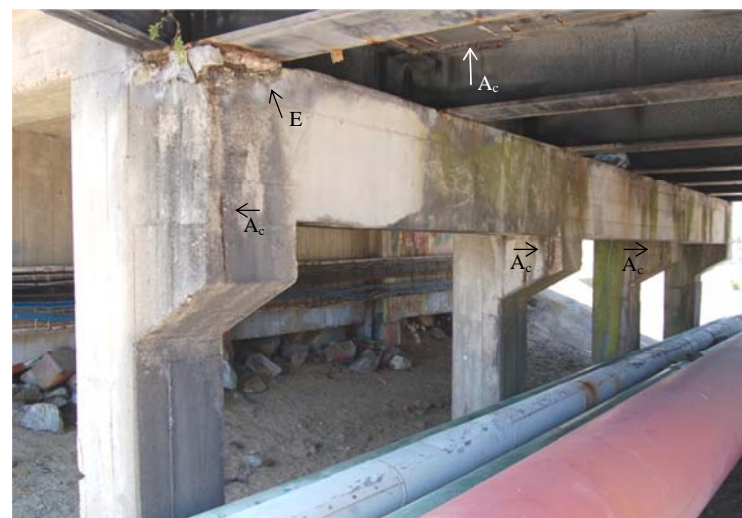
Pilar sul, face este da viga de travamento dos pórticos
